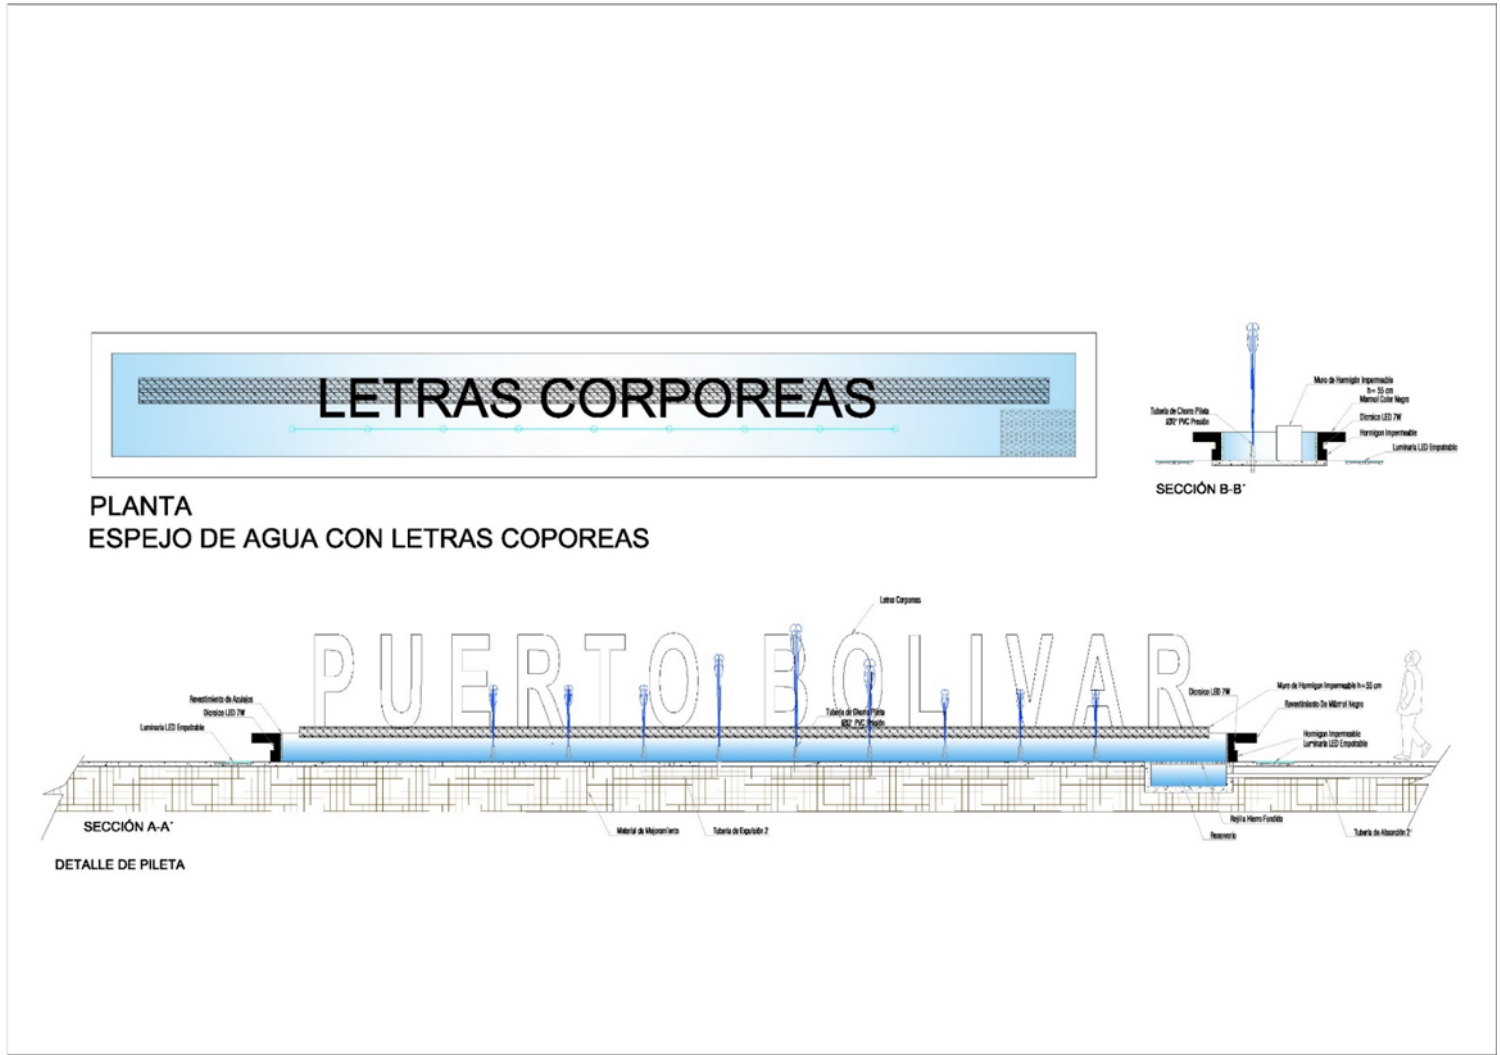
Detalle en Anexo 16. Elaboración: Propia.
